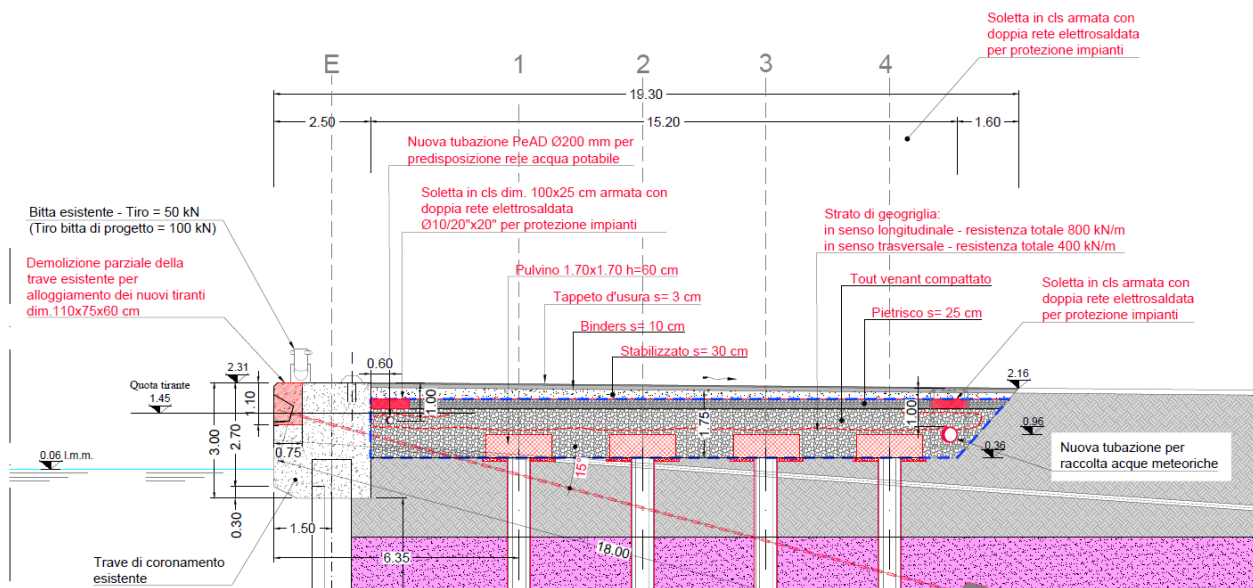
Sezione di progetto con indicazione della posizione delle predisposizioni impiantistiche
